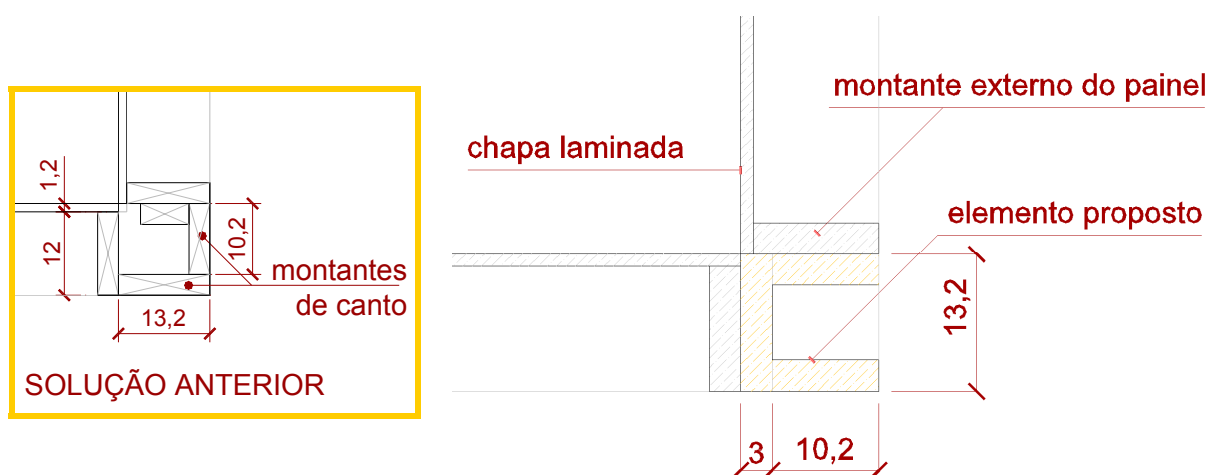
Elemento pré-fabricado para fechar o canto dos painéis
